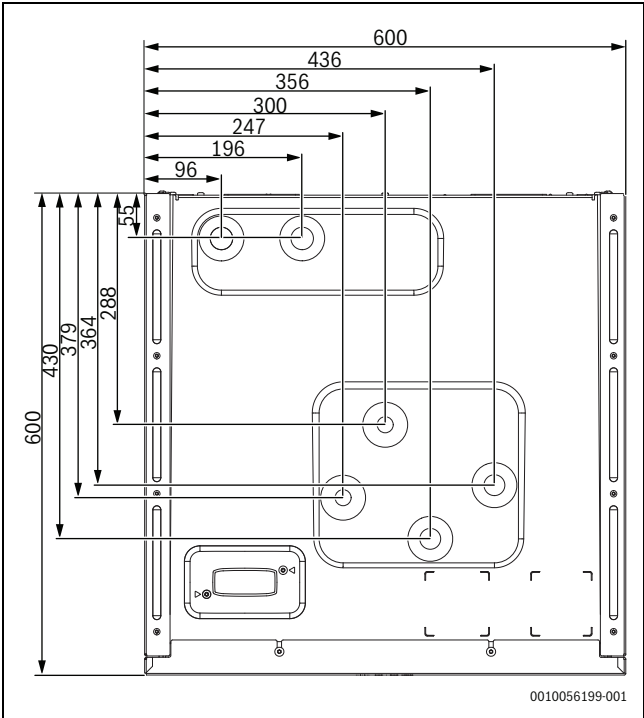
Abmessungen, Anschlüsse, Draufsicht
